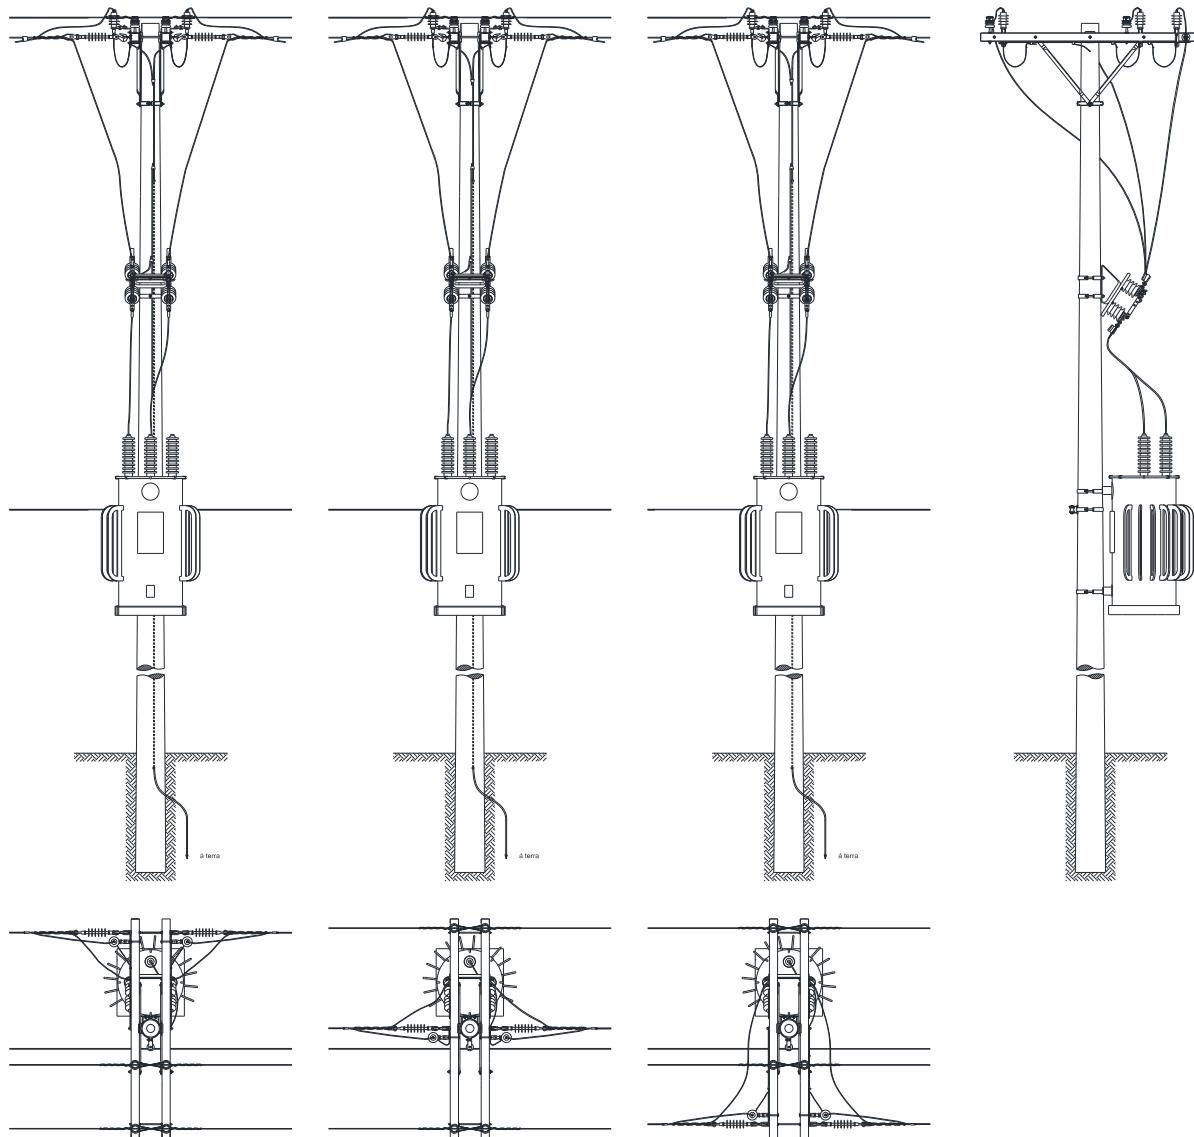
Instalação de equipamento – Regulador de tensão – Ligação estrela aterrado – Estrutura em poste
